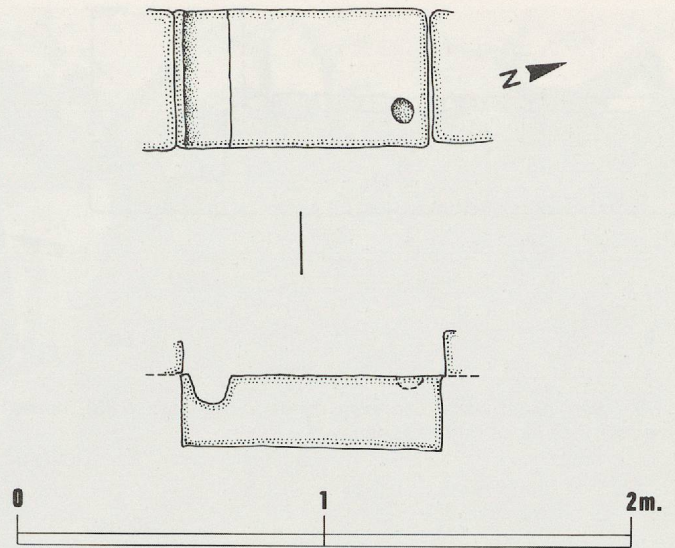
Bât. ouest, locaux L2 et L3 : plan et coupe du seuil dans le mur M31 (st. 115). Etat II.
